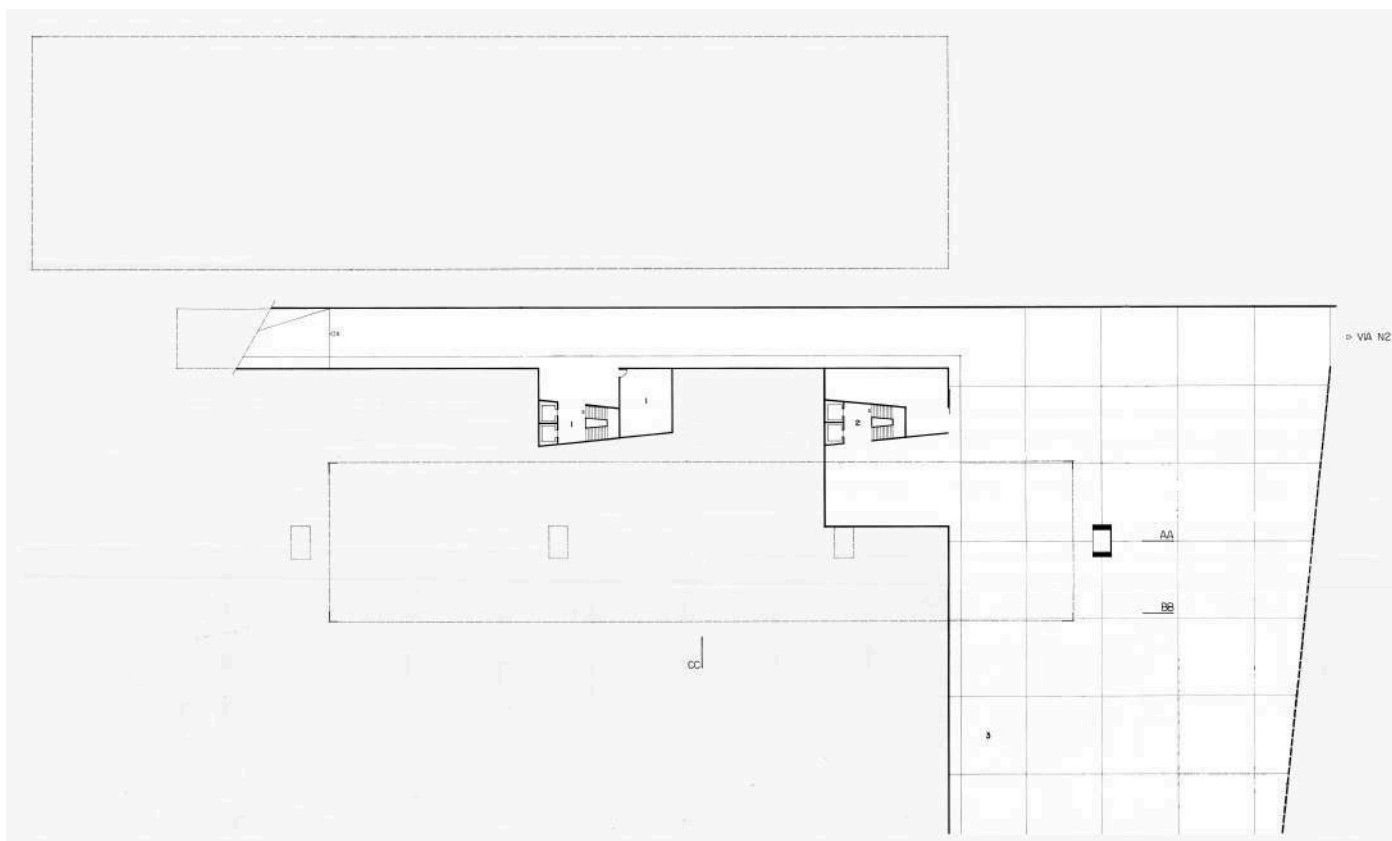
Planta do subsolo da Secretaria da Cultura, 1992. Fonte: ArqPDF.
